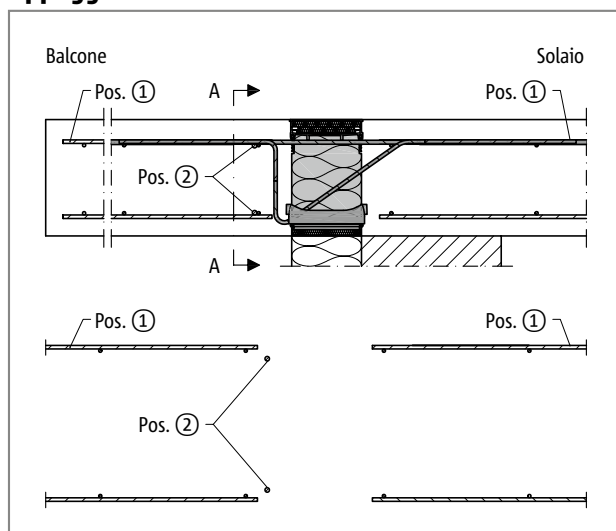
Schöck Isokorb® XT tipo KL: armatura in opera con appoggio diretto
